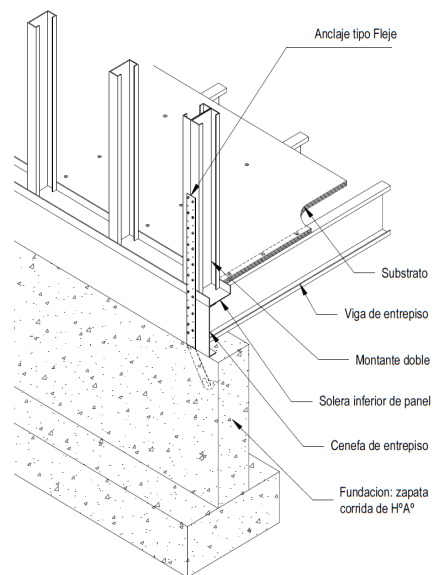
Zapata corrida mostrando el anclaje y la cámara.
